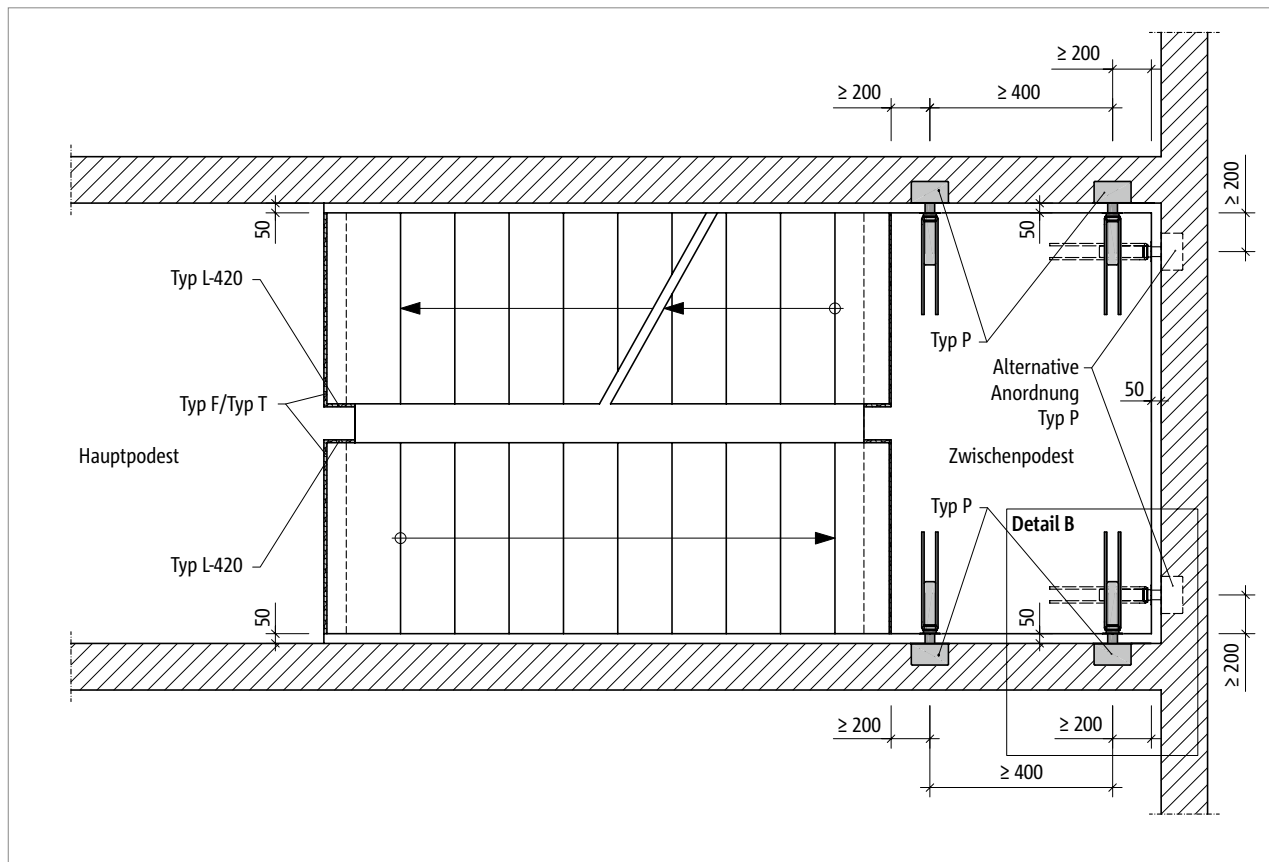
Tronsole® P: Elementanordnung im Grundriss bei einer Fugenbreite von 50 mm
